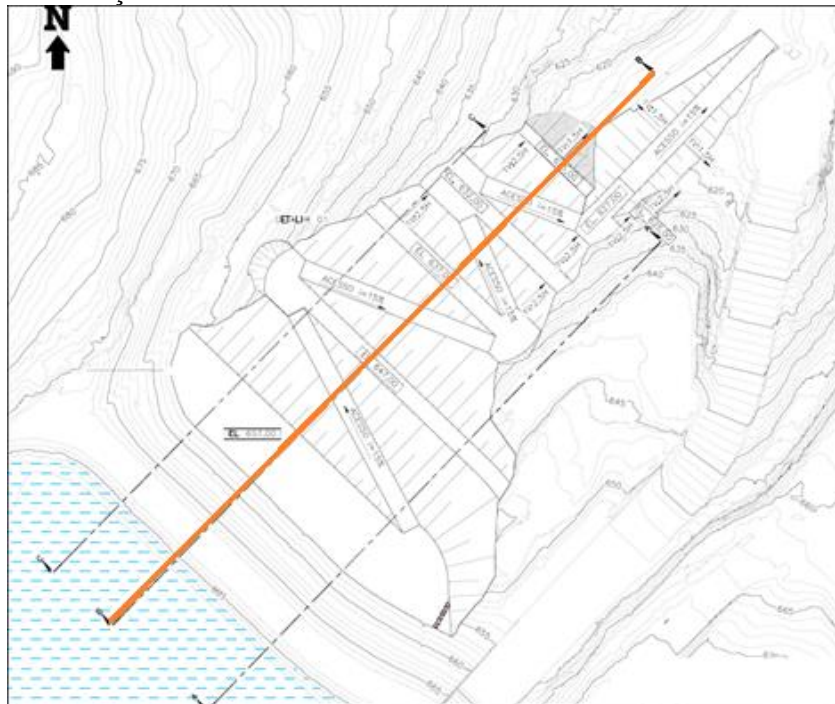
Indicação das seções transversais de análise com as obras de reforço - Planta
